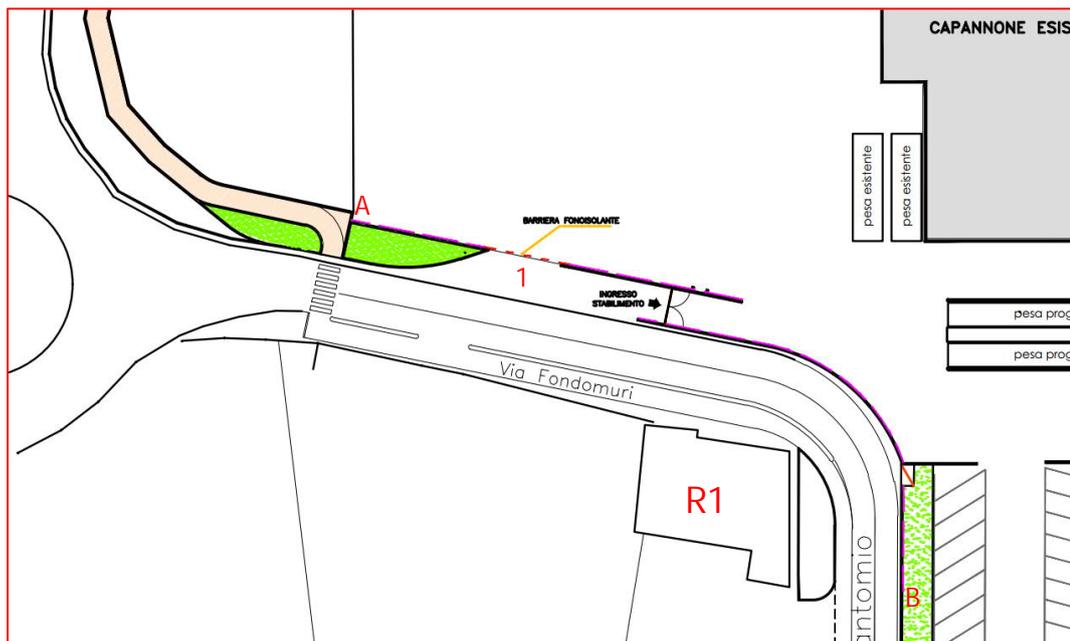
CONFIGURAZIONE PLANIMETRICA DELLA BARRIERA ACUSTICA AREA INGRESSO IMPIANTO
